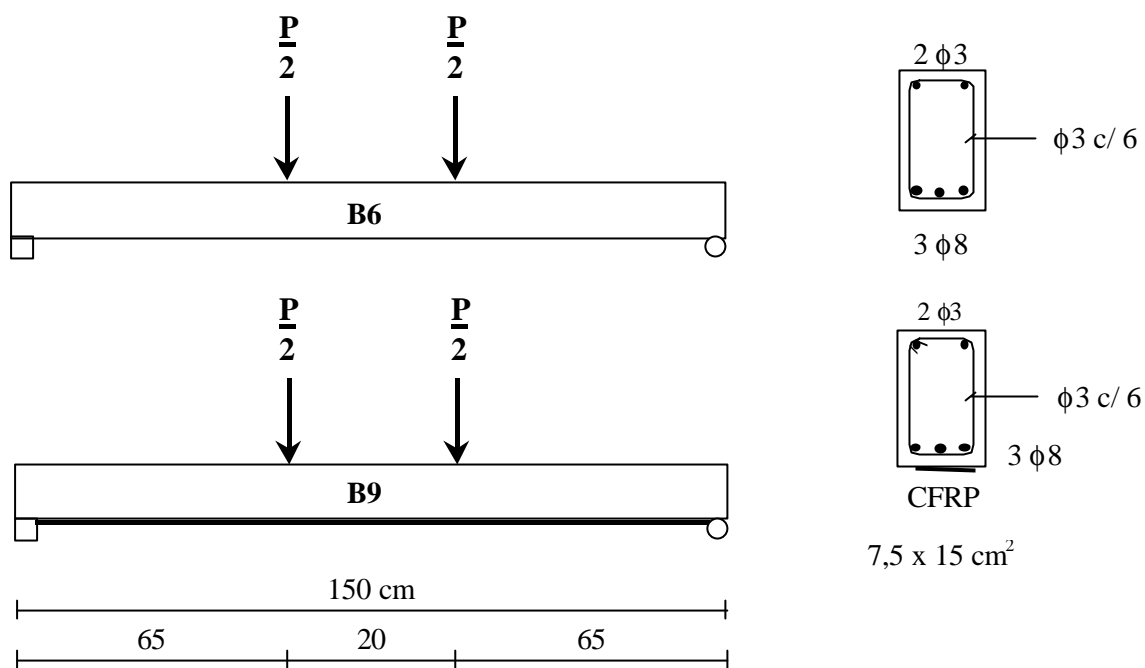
Geometria e carregamento das vigas B6 e B9
